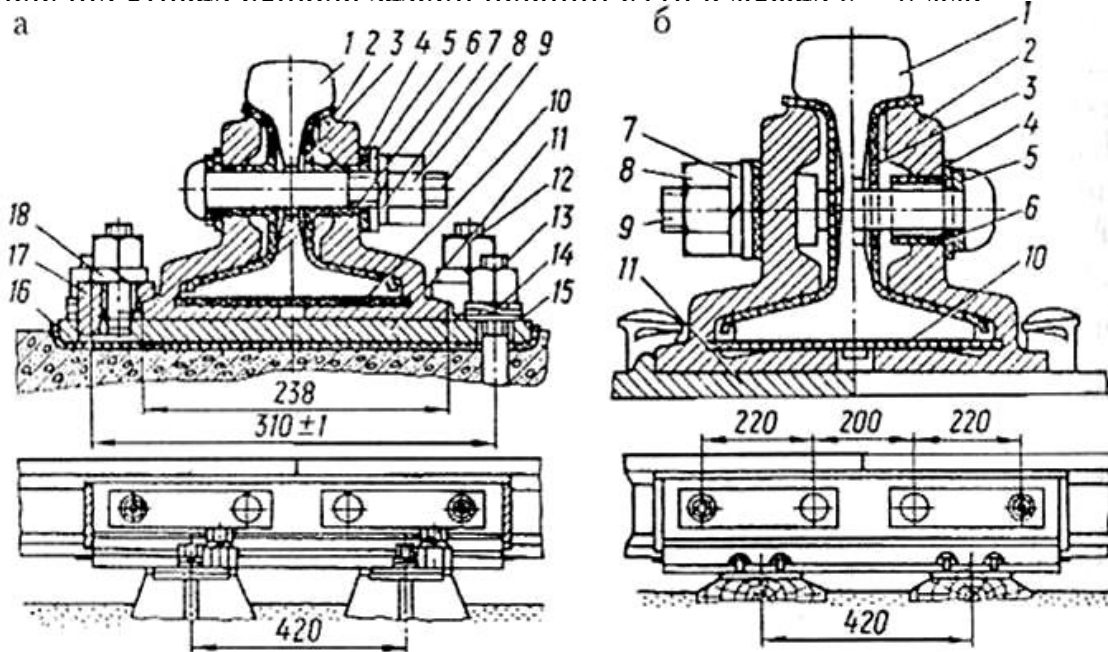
Ізоляційний стик з облягаючими металевими накладками:
